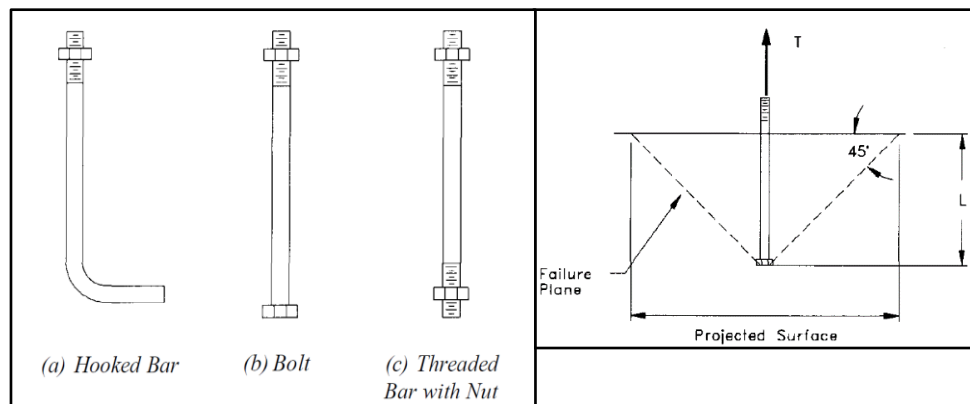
Tipos de anclaje al concreto - Cono de arrancamiento.
